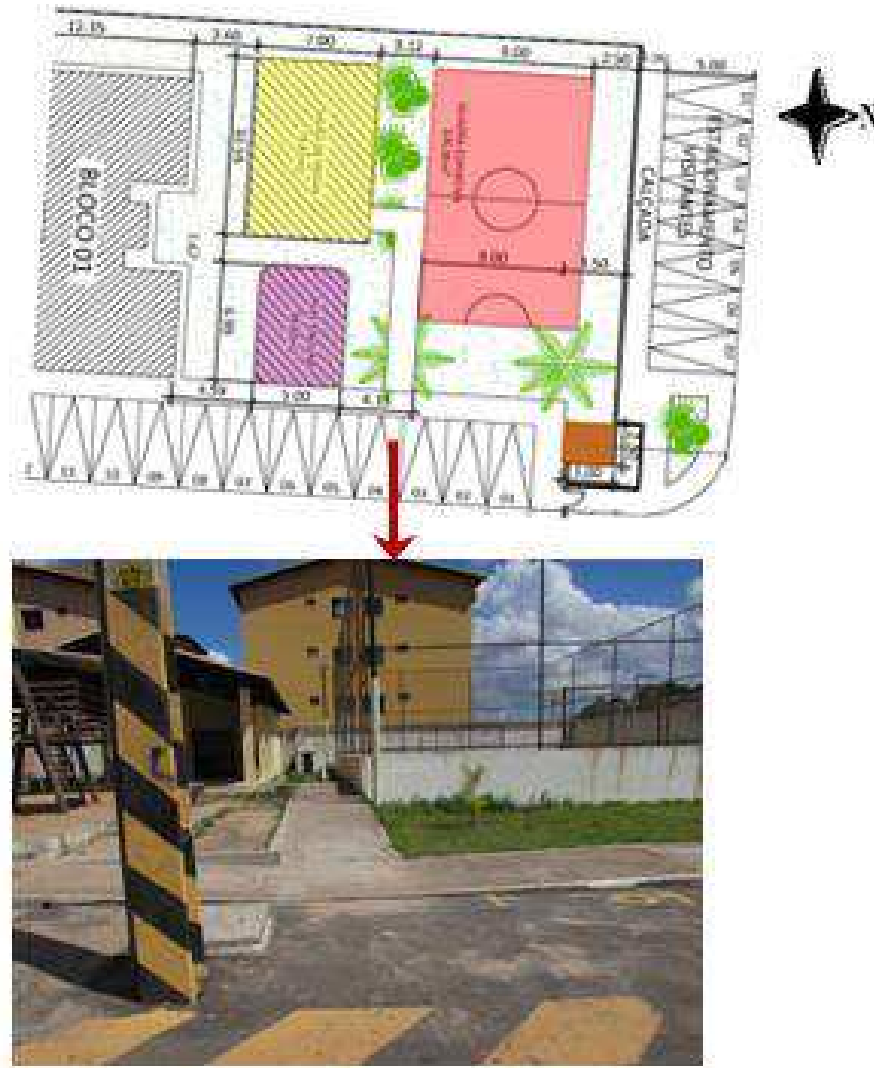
Planta Baixa da Área de Lazer do Conjunto São José III
